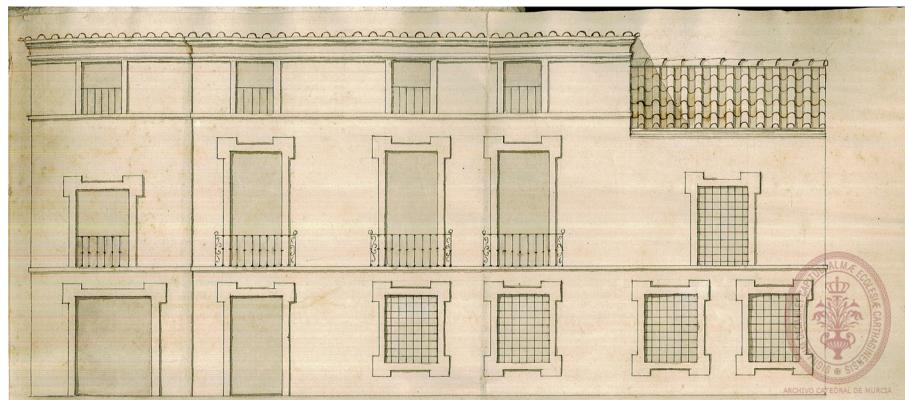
Alzado de la fachada de una casa propiedad del cabildo de la Catedral de Murcia. Martín Solera, 1756
